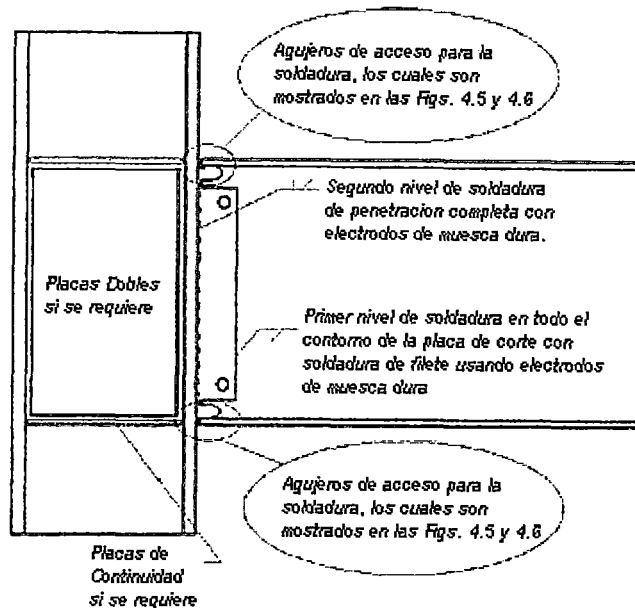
Detalle de soldadura en la conexión (FEMA 355D, 2000)
